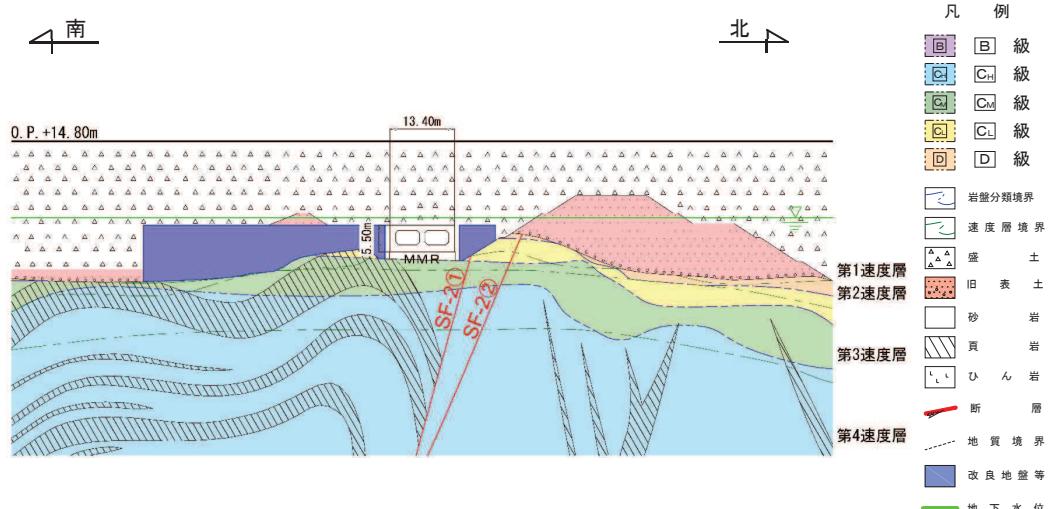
取水路（標準部）地質断面図（断面⑥：曲線部）
